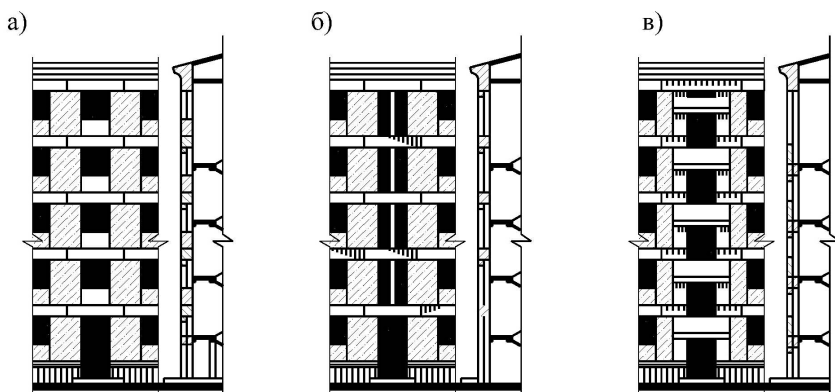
Варианты разрезки на блоки наружной стены лестничной клетки:
